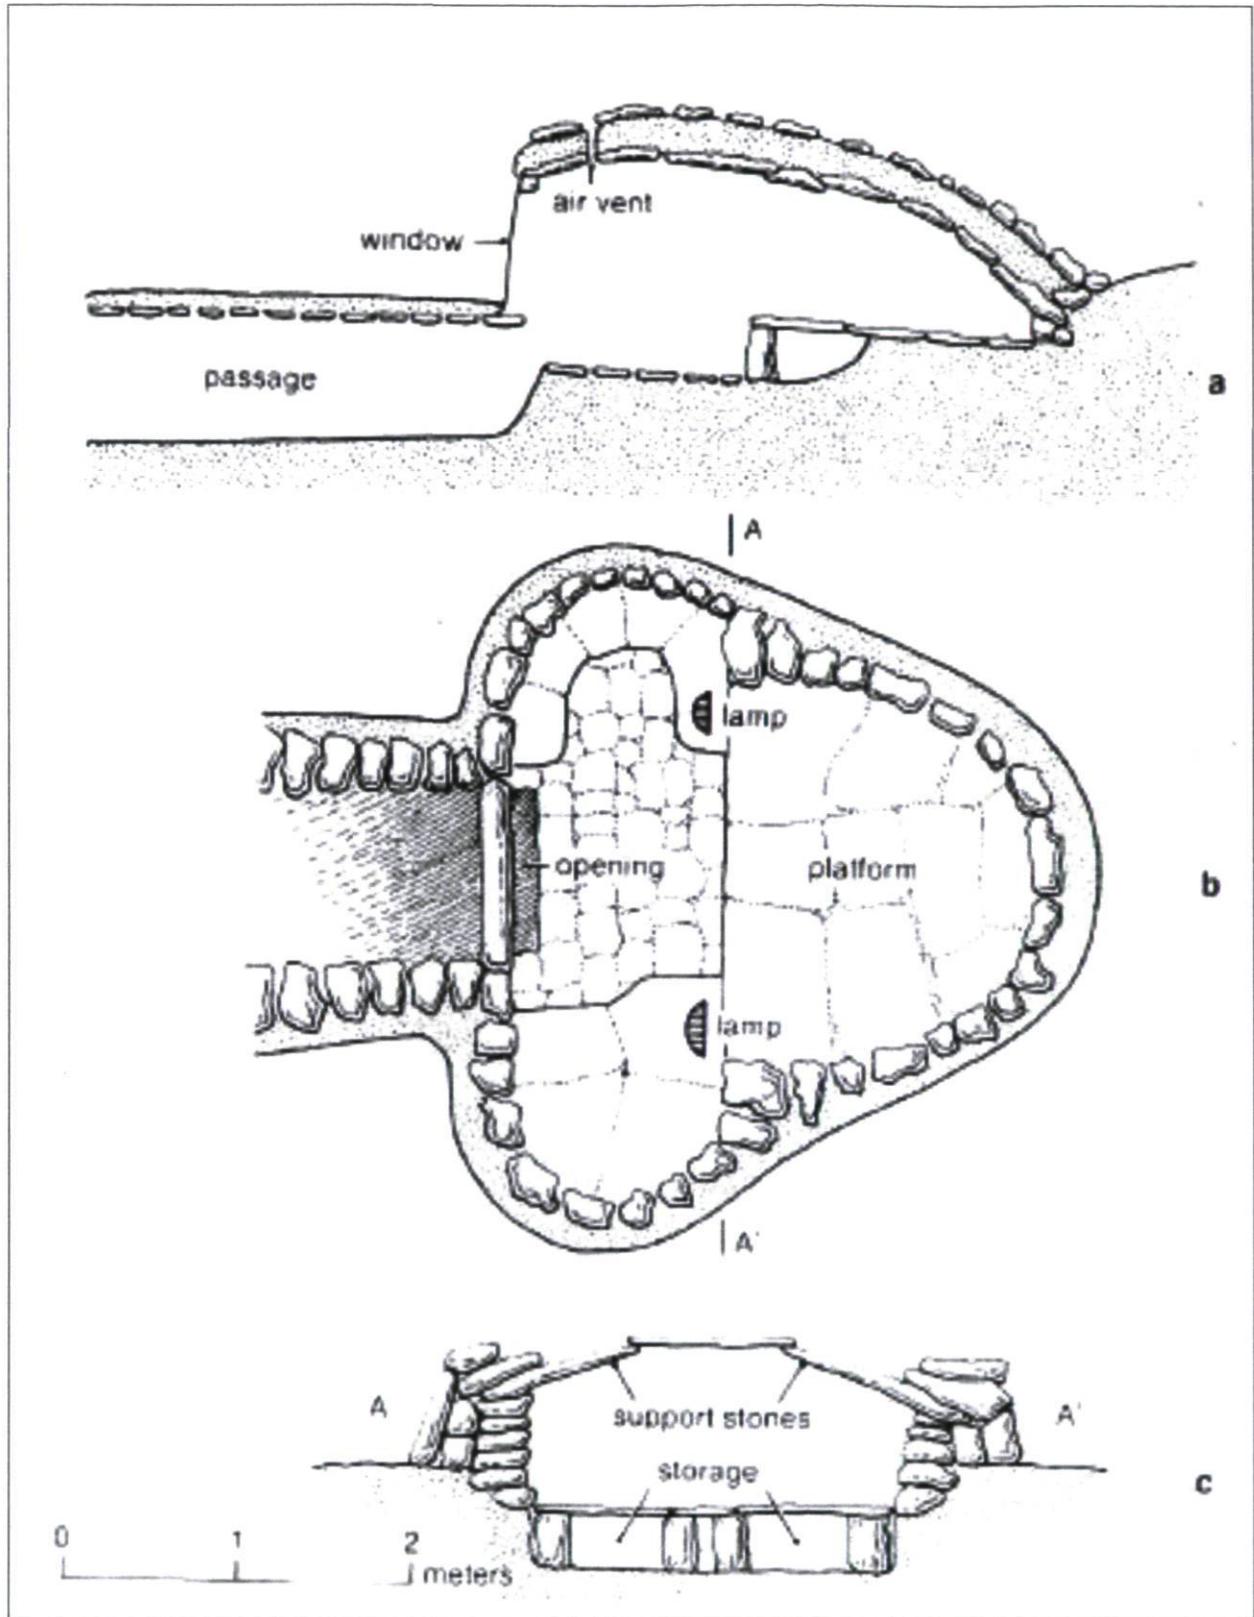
Plan d'une maison inughuite (Kleivan 1978 :526).
